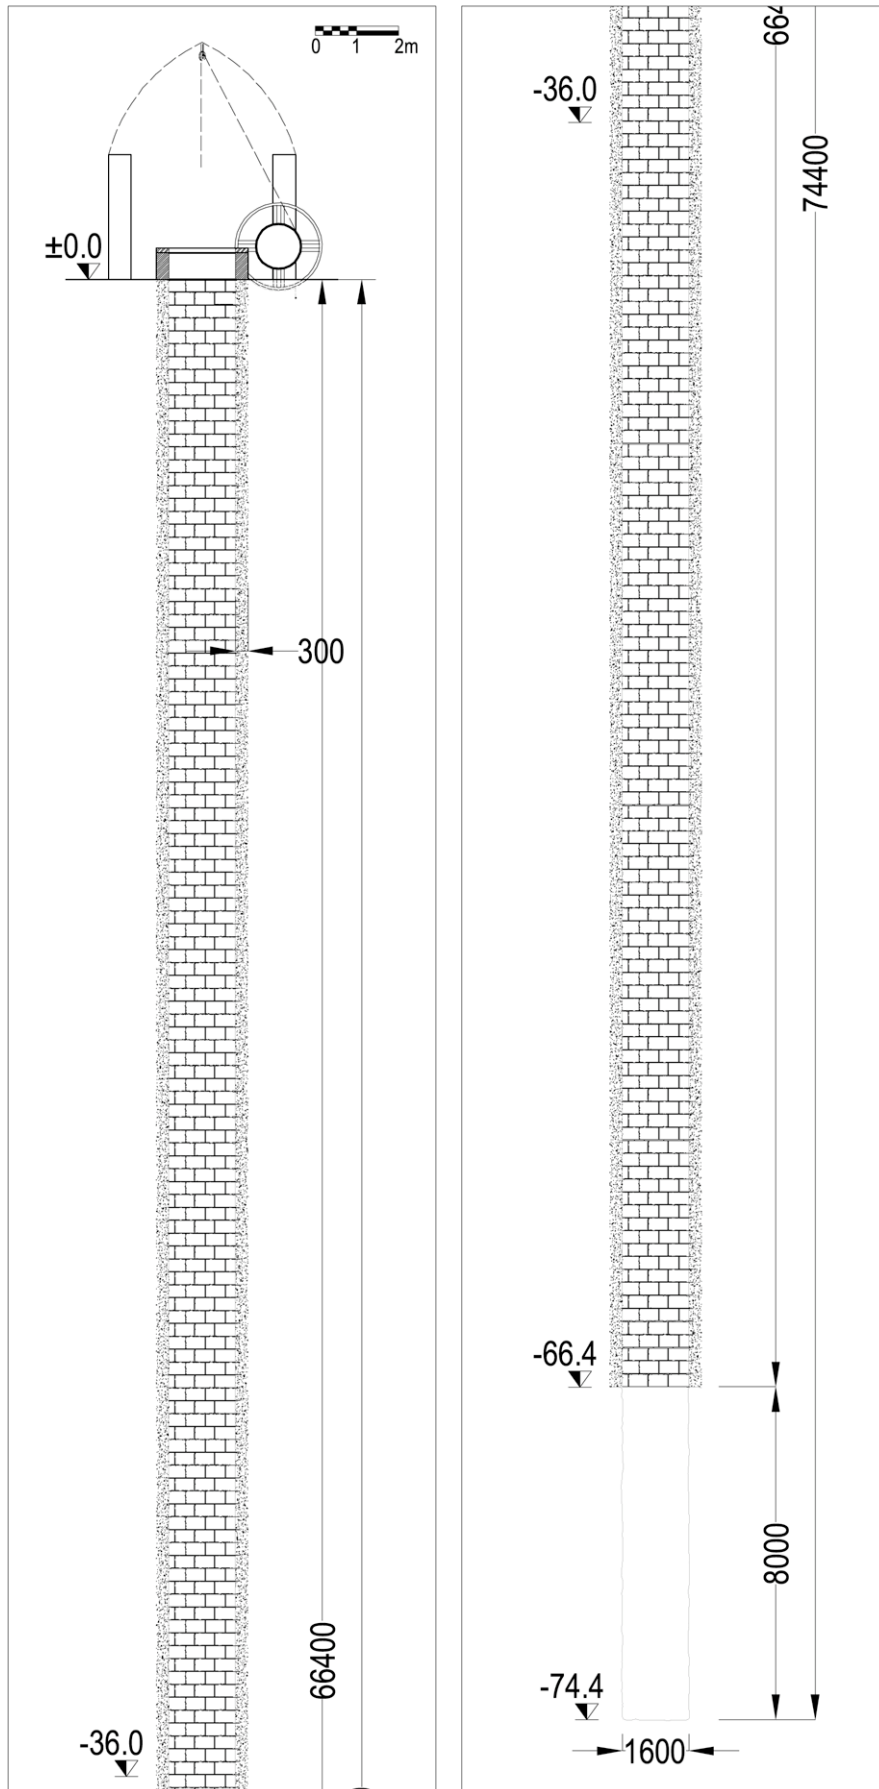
Sezione longitudinale dell’antico pozzo di Lazzate (a cura dell’Arch. Roberto Basilico).
